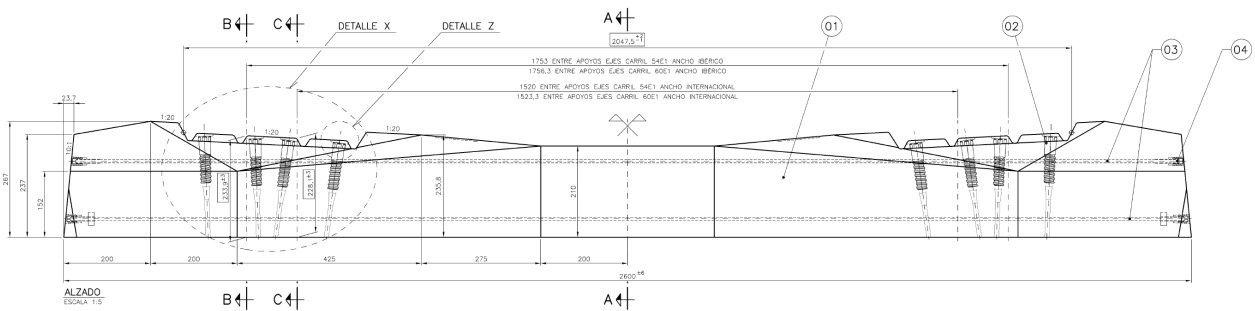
Plano de alzado de traviesa PR-10. Fuente: Andaluza de Traviesas, S.A.
